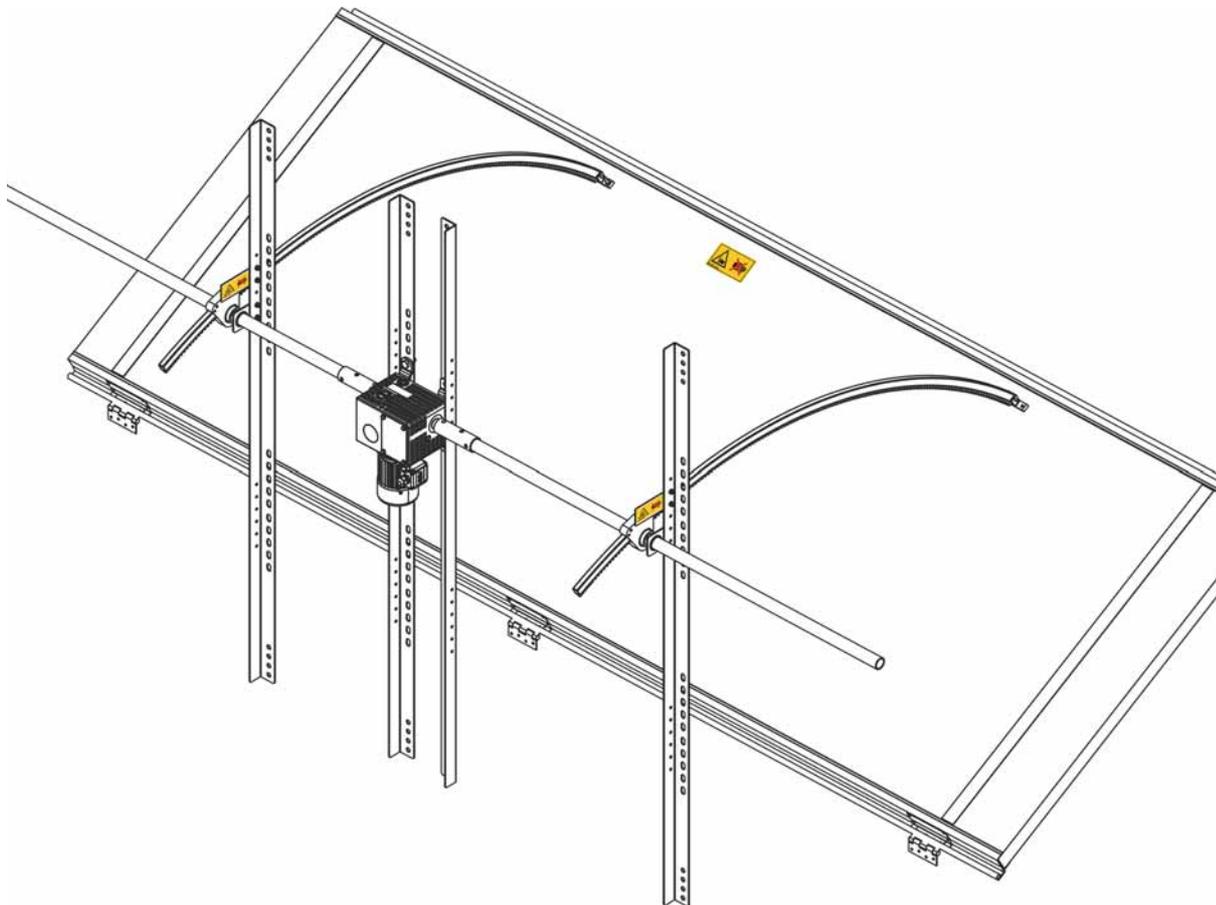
Tunnelklappe mit Zahnstangenantrieb
